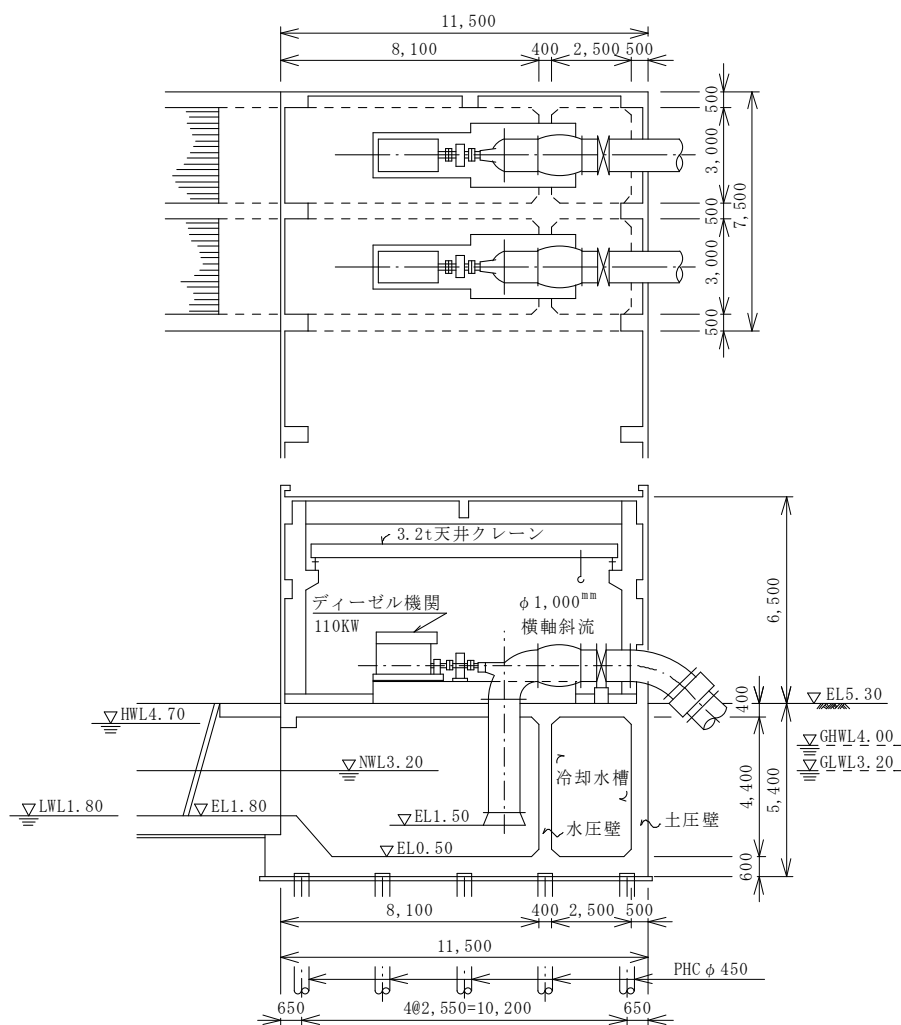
排水ポンプ場（横軸斜流ポンプ）の平面・縦断面図（例）
